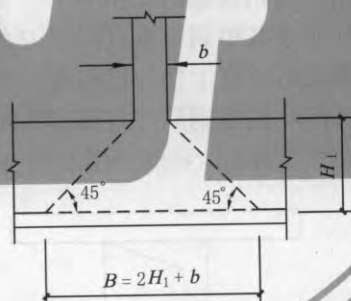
钢筋混凝土墙承受上部柱荷载的截面计算宽度
